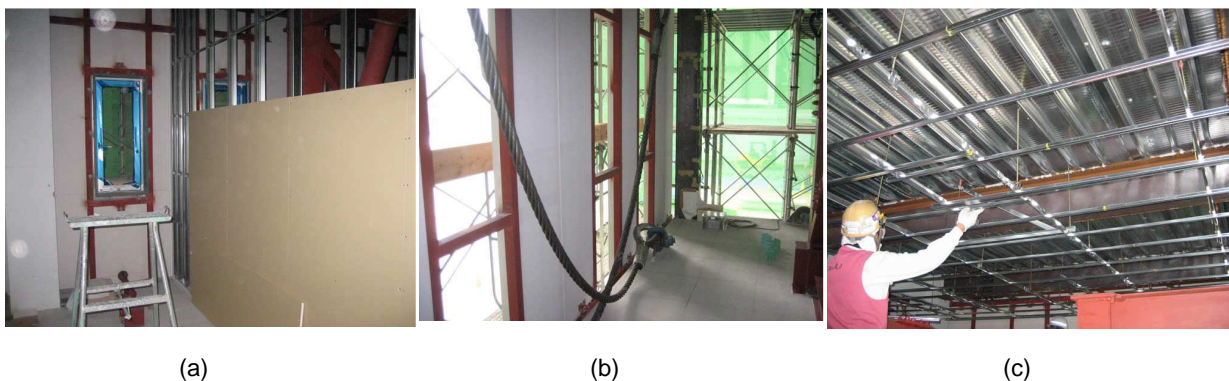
Divisórias instaladas em LGS (a); caixilharia em alumínio nos painéis de ALC exteriores (b); bitolas metálicas para o tecto falso (c)
